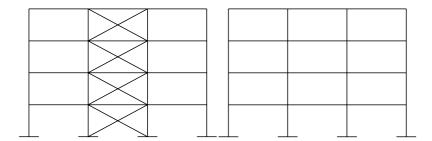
Pórtico arriostrado (puede ser traslacional si es muy flexible) y pórtico no arriostrado (puede ser intraslacional si es rígido horizontalmente)
